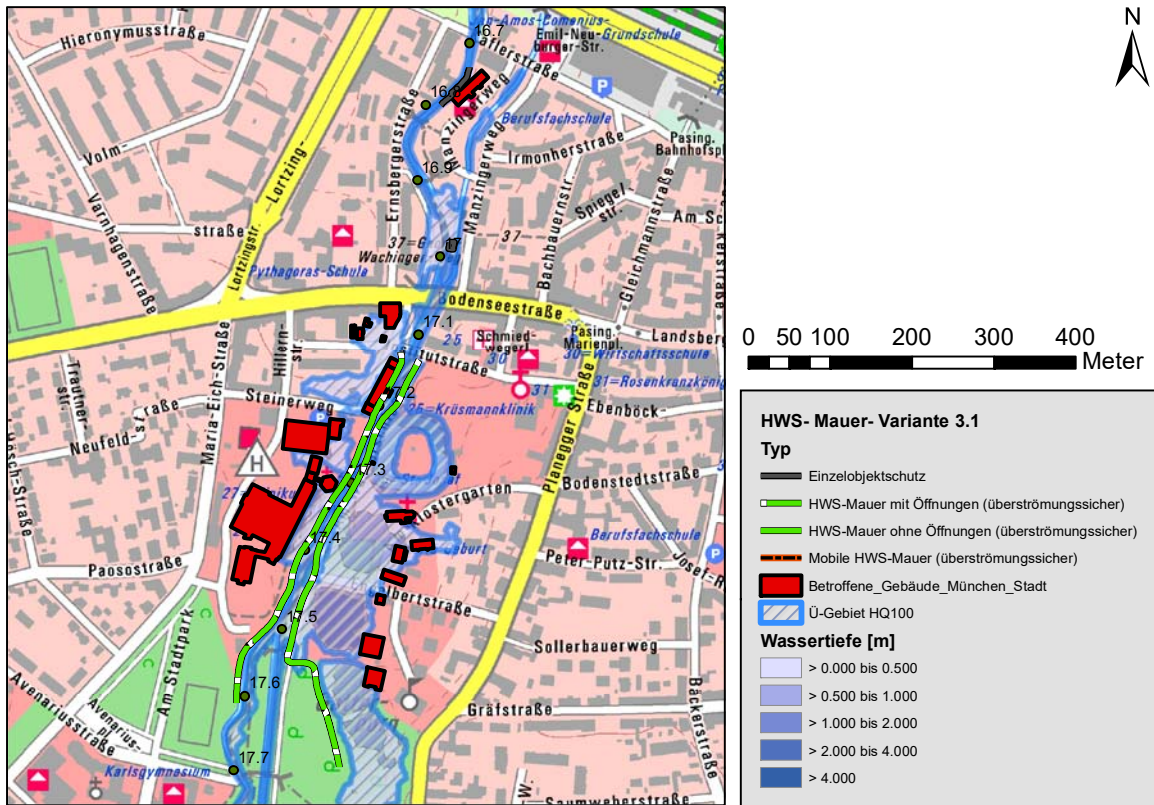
Lageplan für Variante 3.1 - Abschnitt 1
